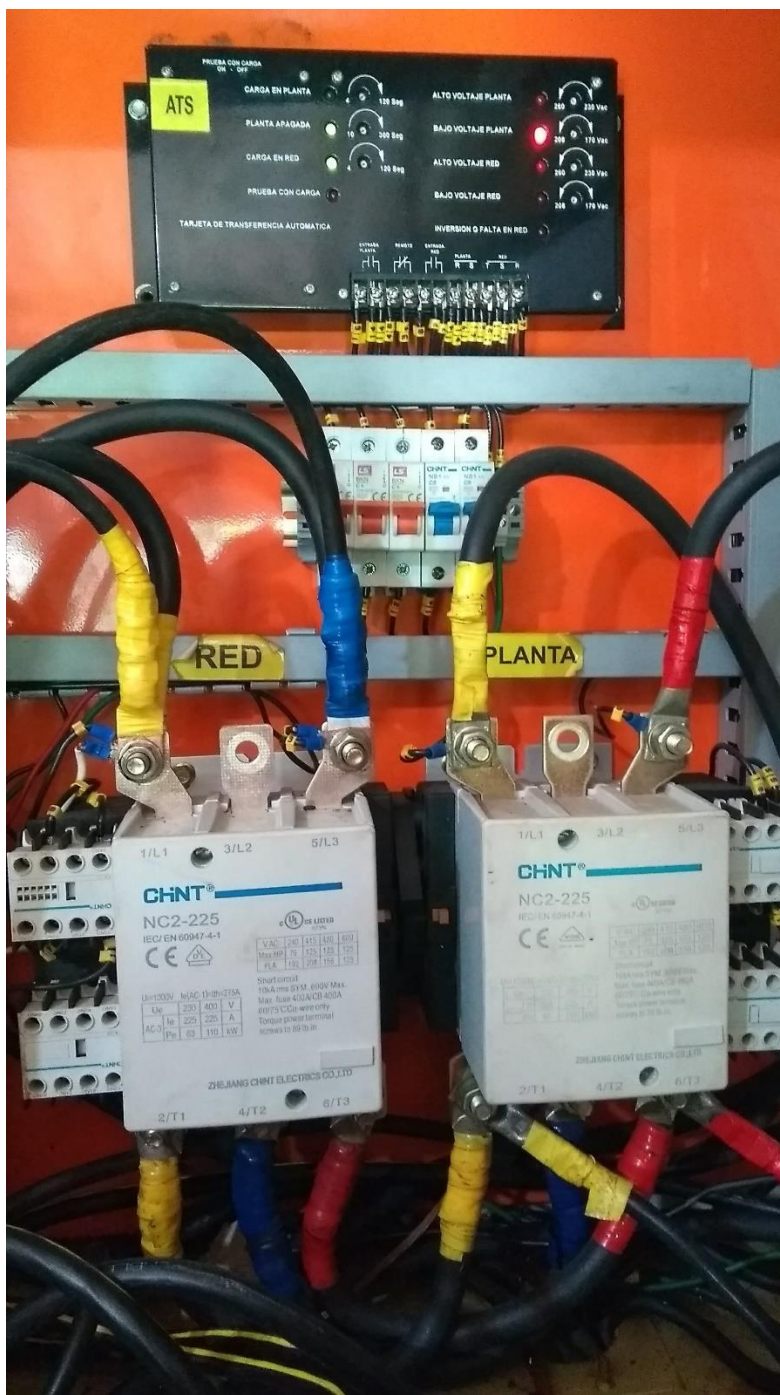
, sistema bypass para entrada de planta eléctrica a acometida principal
